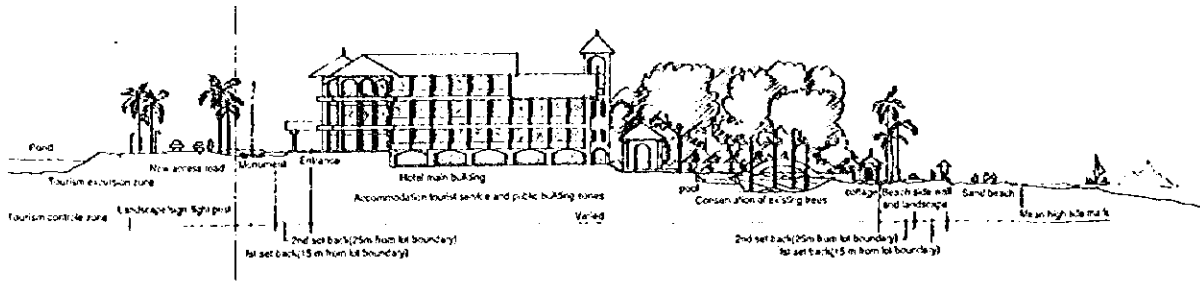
Planta Típica del Desarrollo Hotelero en el Área Central de Chame
